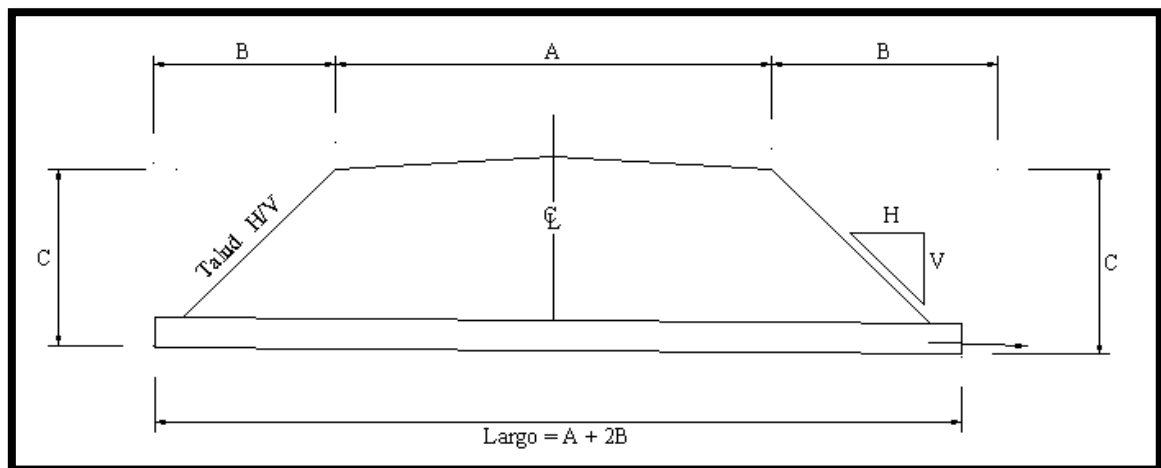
Cálculo de longitud de una alcantarilla con pendiente suave (Mecánica de Suelos)
